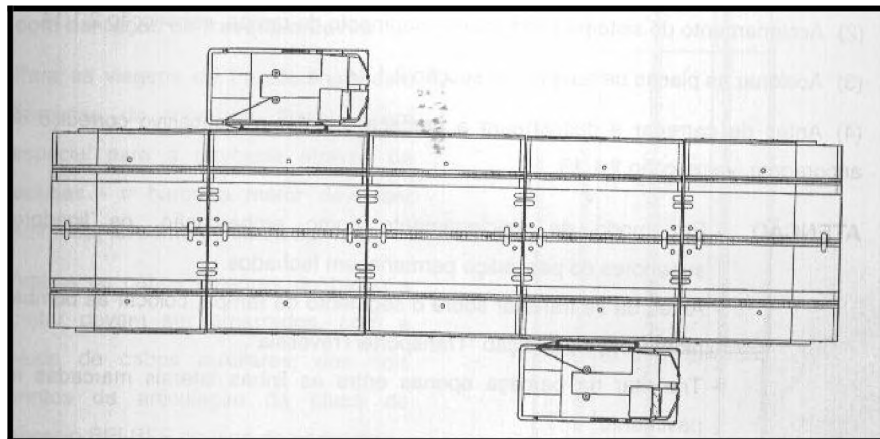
Portada de cinco módulos com embarcações paralelas à faixa de rodagem
